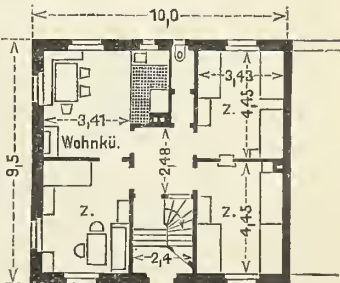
Grundriß zu Abb. 5. Vierfamilienhaus.
